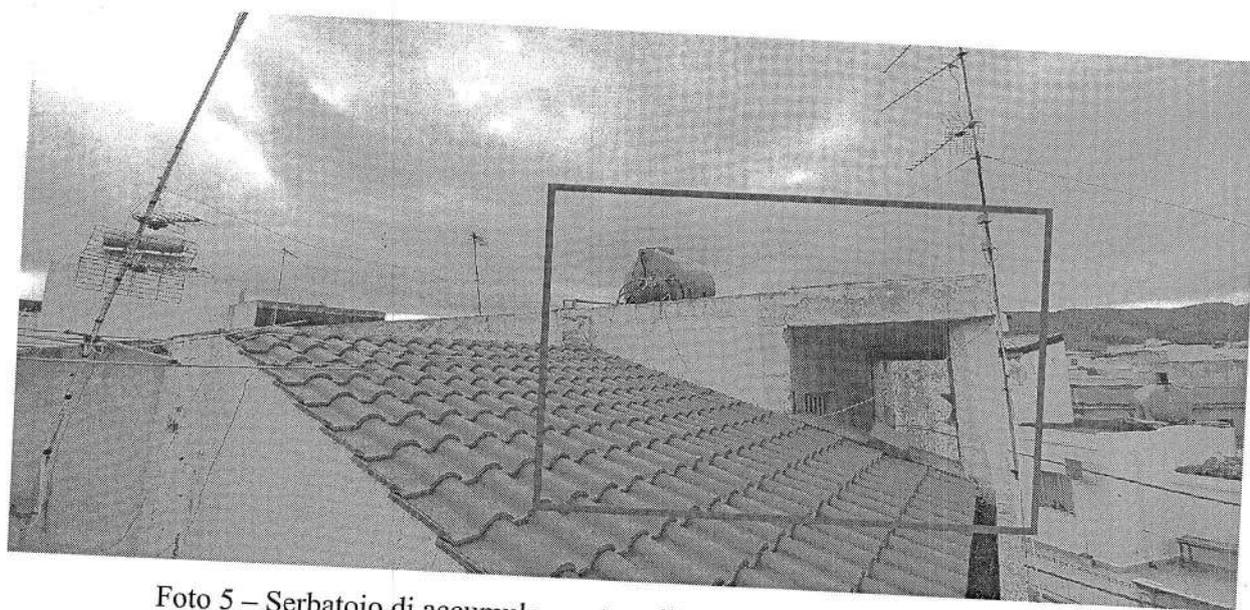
Serbatoio di accumulo, posto sull'unità immobiliare non pignorata
